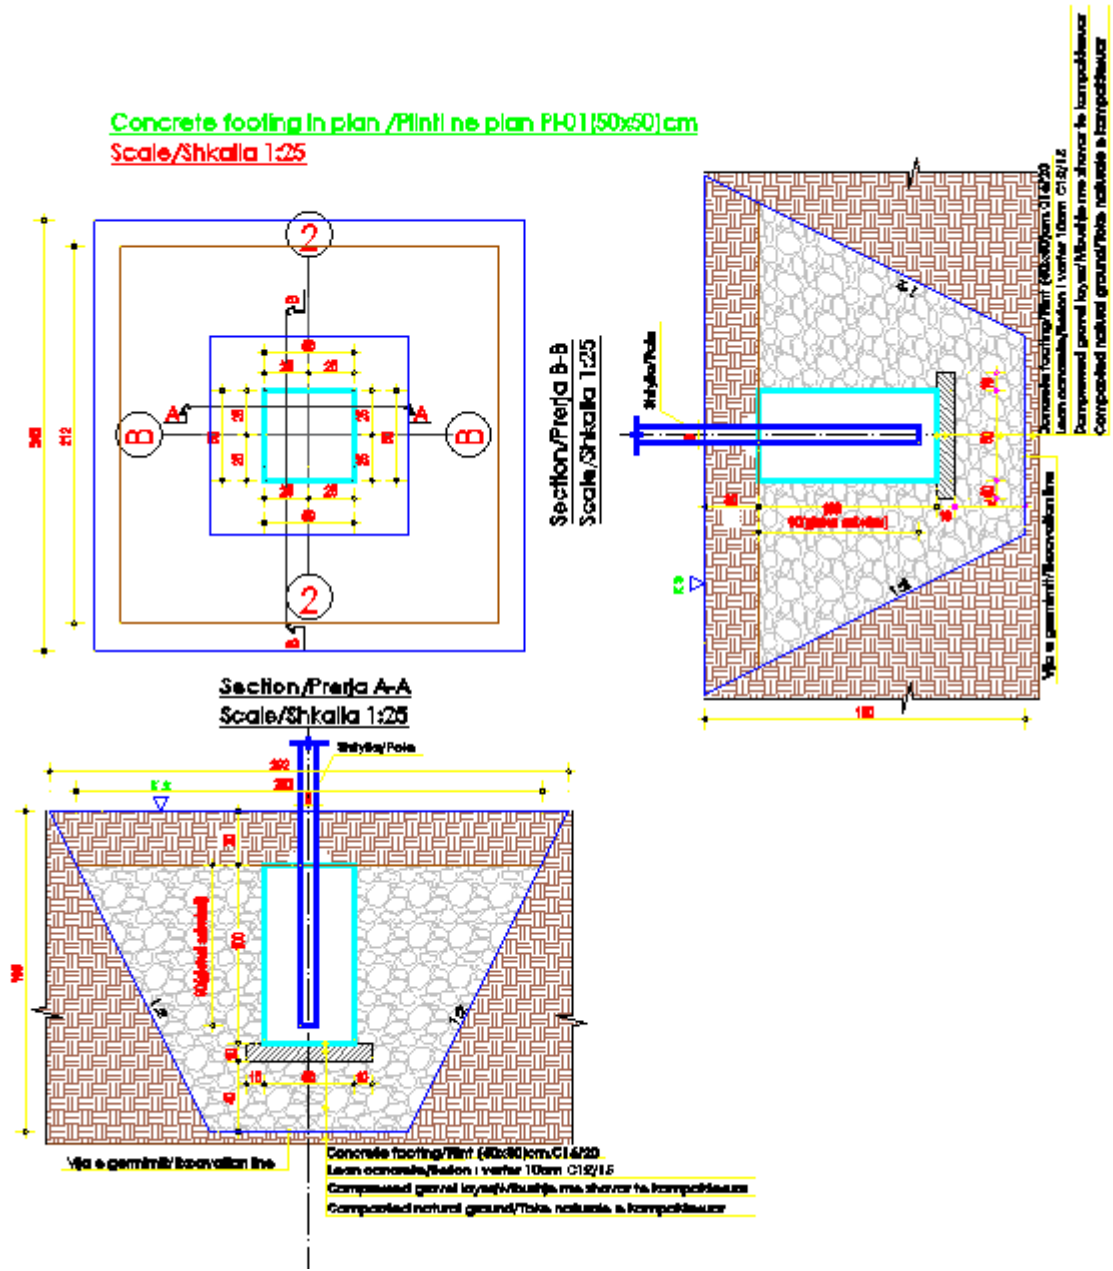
Dimensioi Gjeometrik I bazamentit te betonit
